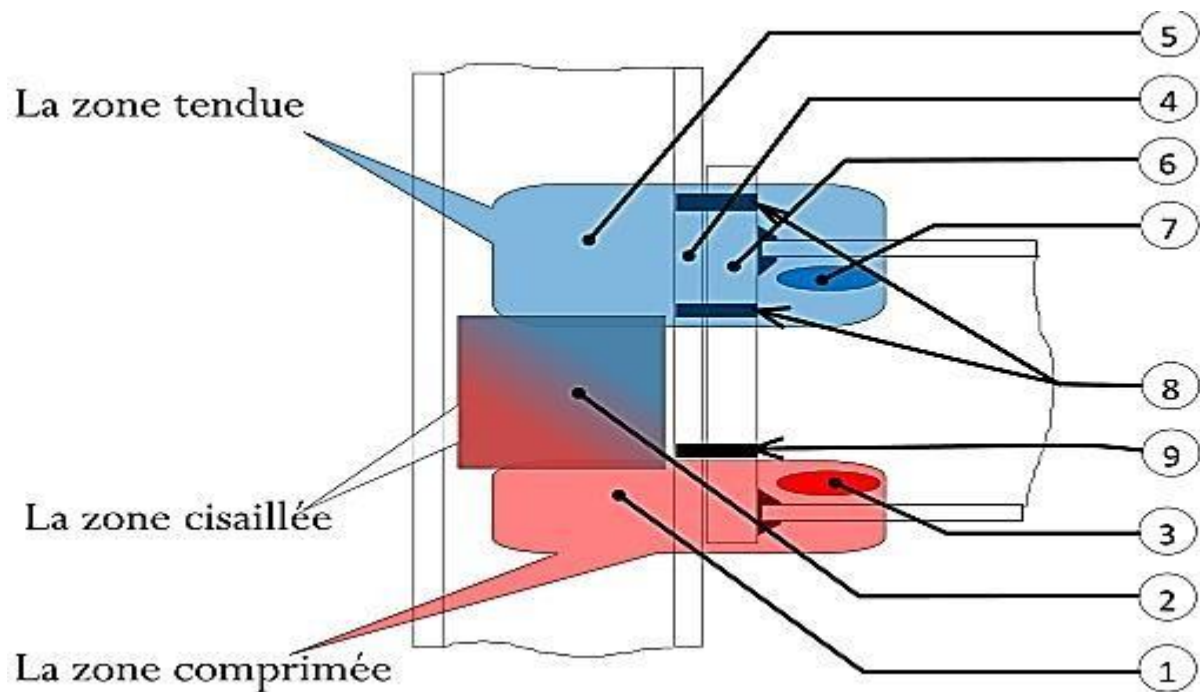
Composantes d'un assemblage poutre-poteau boulonné par platine d'extrémité. [1]
